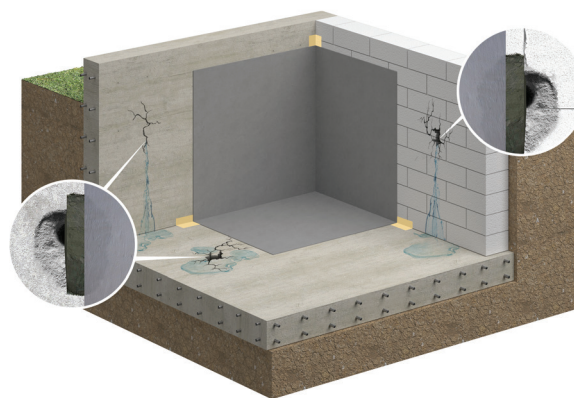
Защита ограждающих конструкций от воздействия грунтовых вод со стороны помещений
